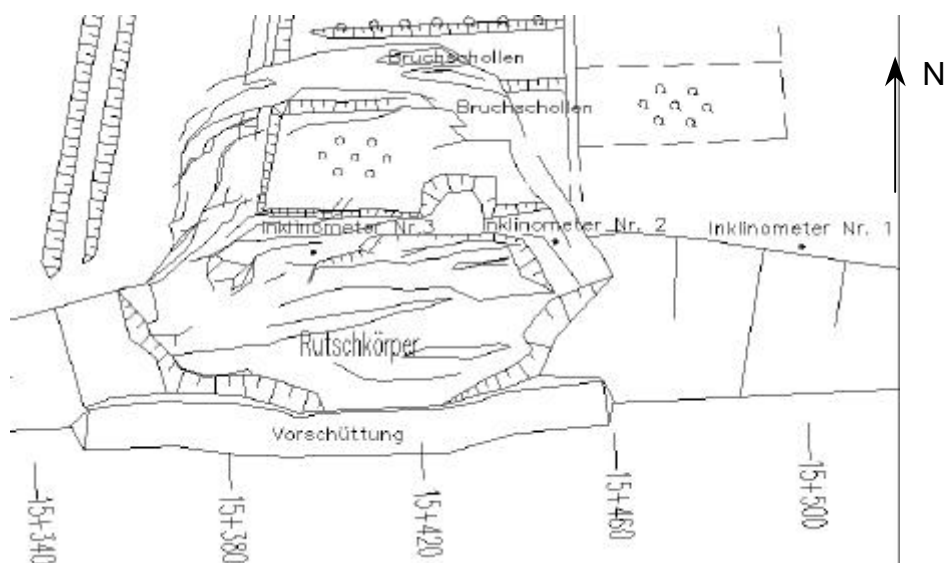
Darstellung der „großen Rutschung“ mit Rissbildung im Grundriss
